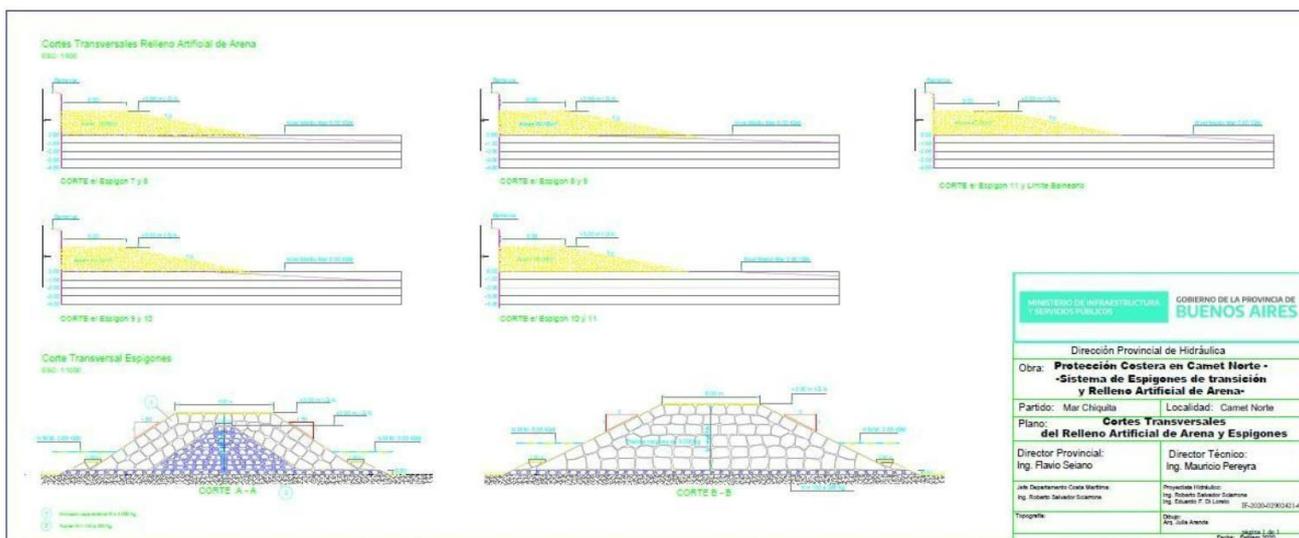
Planimetría de Obra. Elaboración propia DEA-DPH
